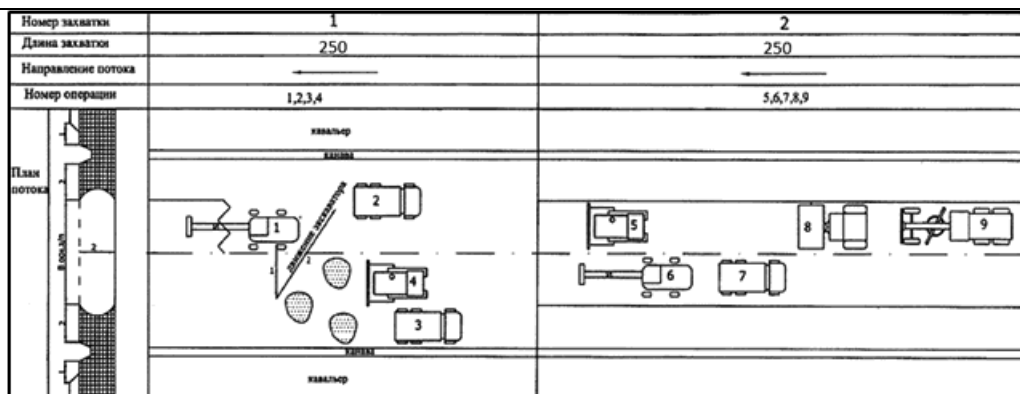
Технологическая схема удаления слабого грунта в основании насыпи
